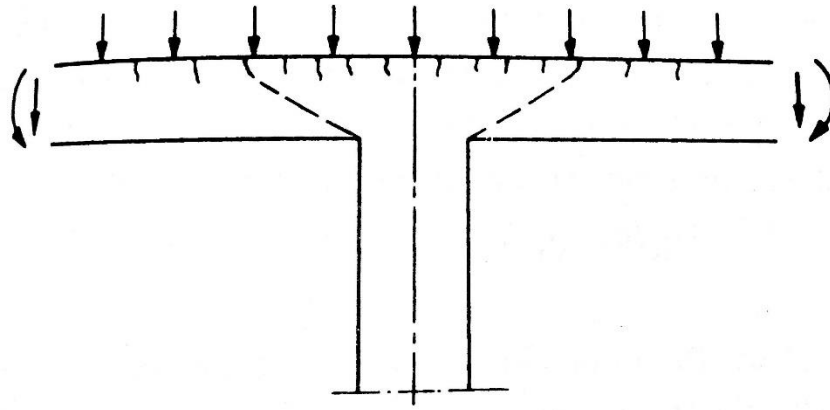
2 - Aspectos das fissuras em uma seção passando pelo pilar. (Leonhardt, 2007)
